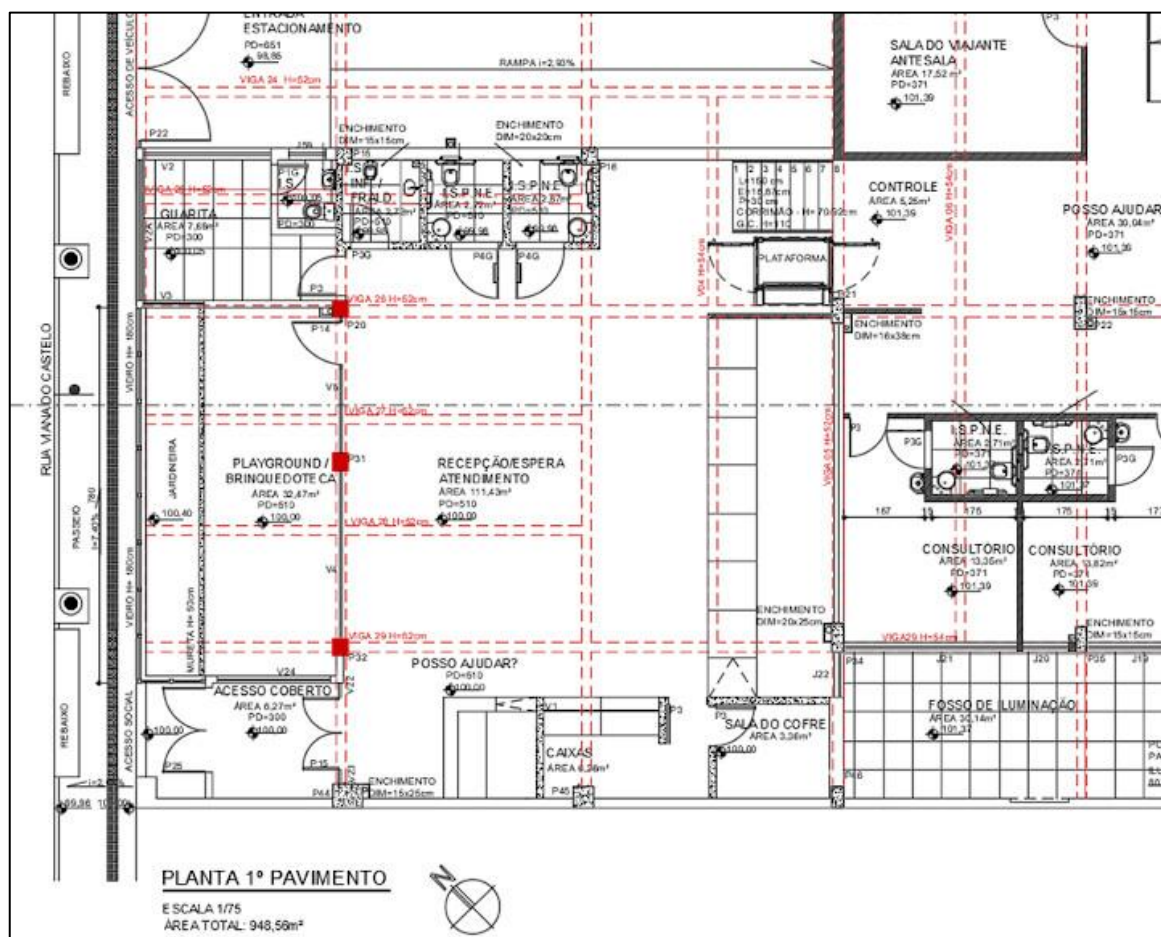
Planta 1º pavimento com representação de pilares na fachada.
